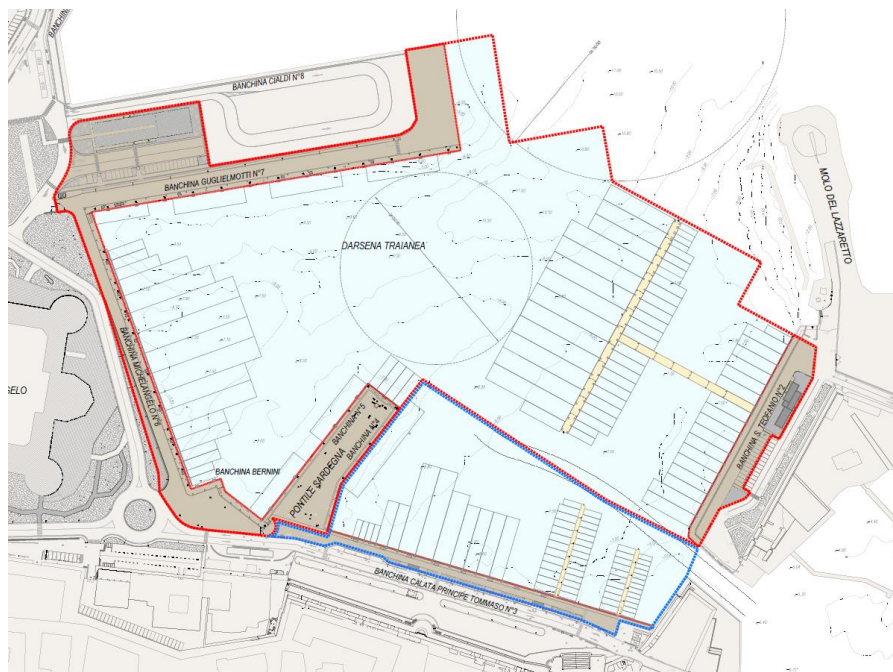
Planimetria aree oggetto di richiesta di concessione demaniale.
